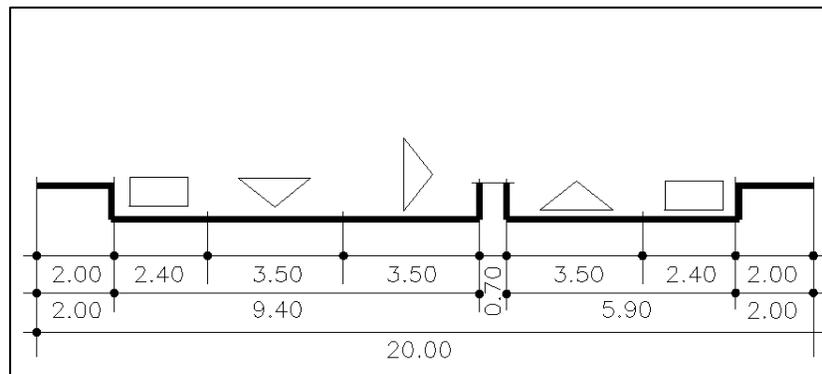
Sección tipo C. Paseo de las Bárcenas
